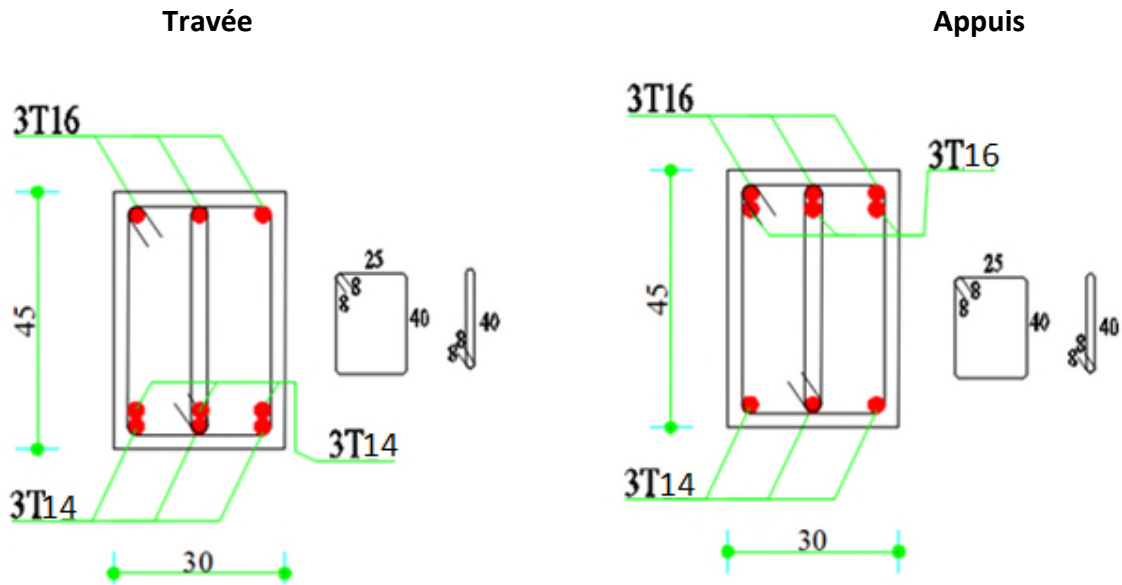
Schéma de ferrailage de la poutre principale des étages courants
